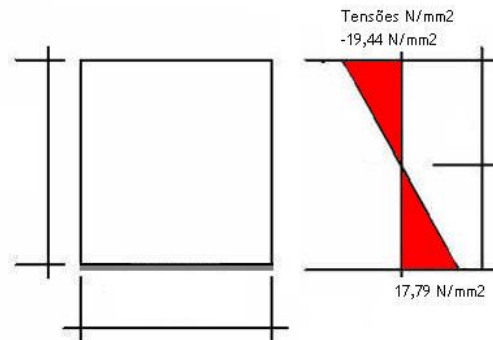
35 – Estado de tensão para uma viga sujeita a um carregamento contrário.
